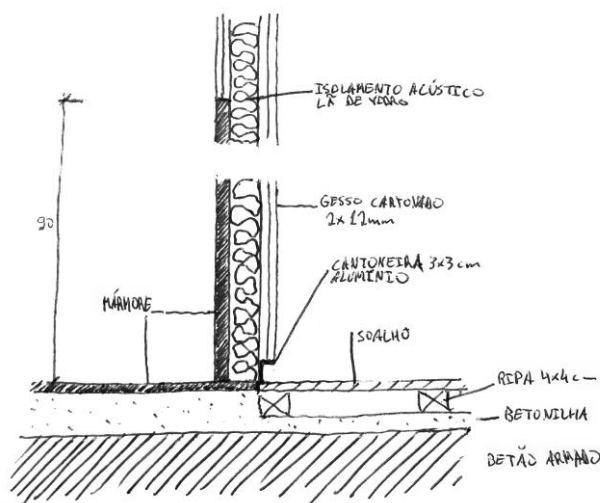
Desenho do remate entre os pavimentos e as paredes.
